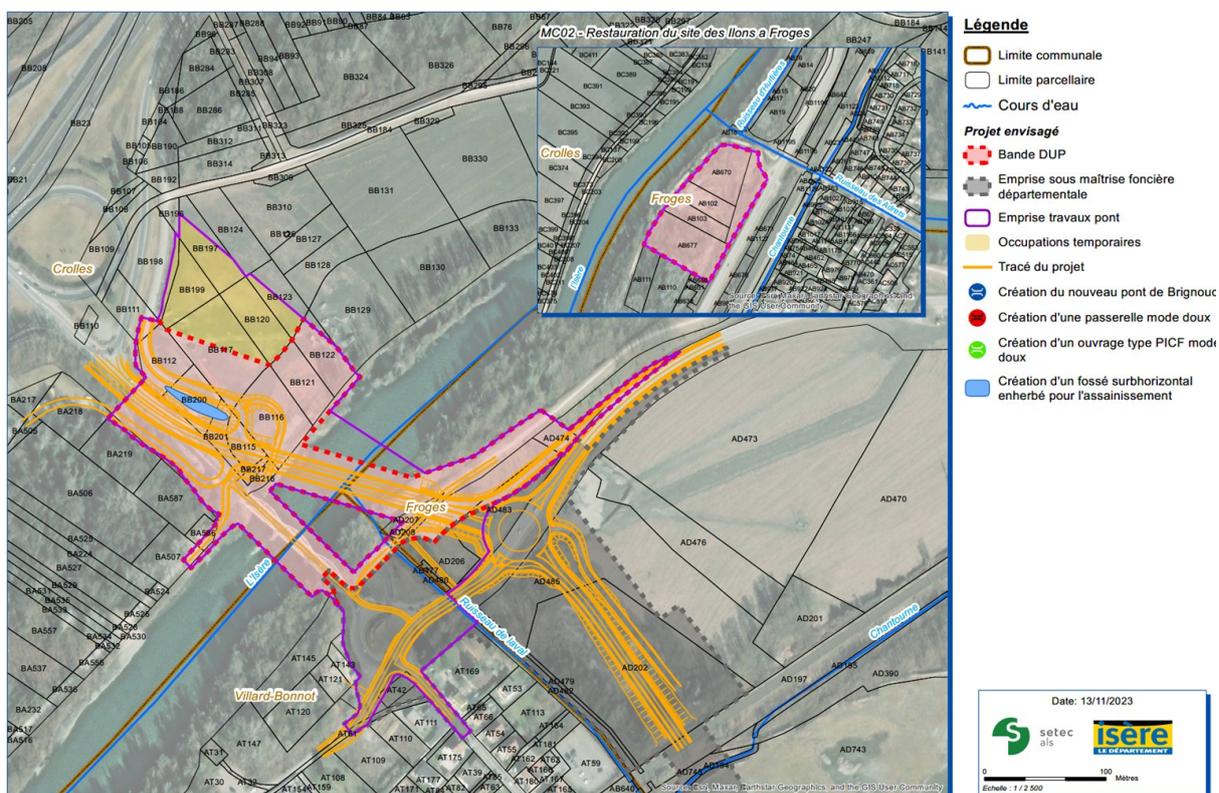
Plan du projet et connexion avec l'opération de suppression du PN27 (source: plan des travaux)
